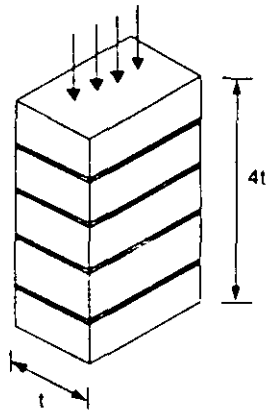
Ensayo de una pila para determinar la resistencia a la compresión de la mampostería
